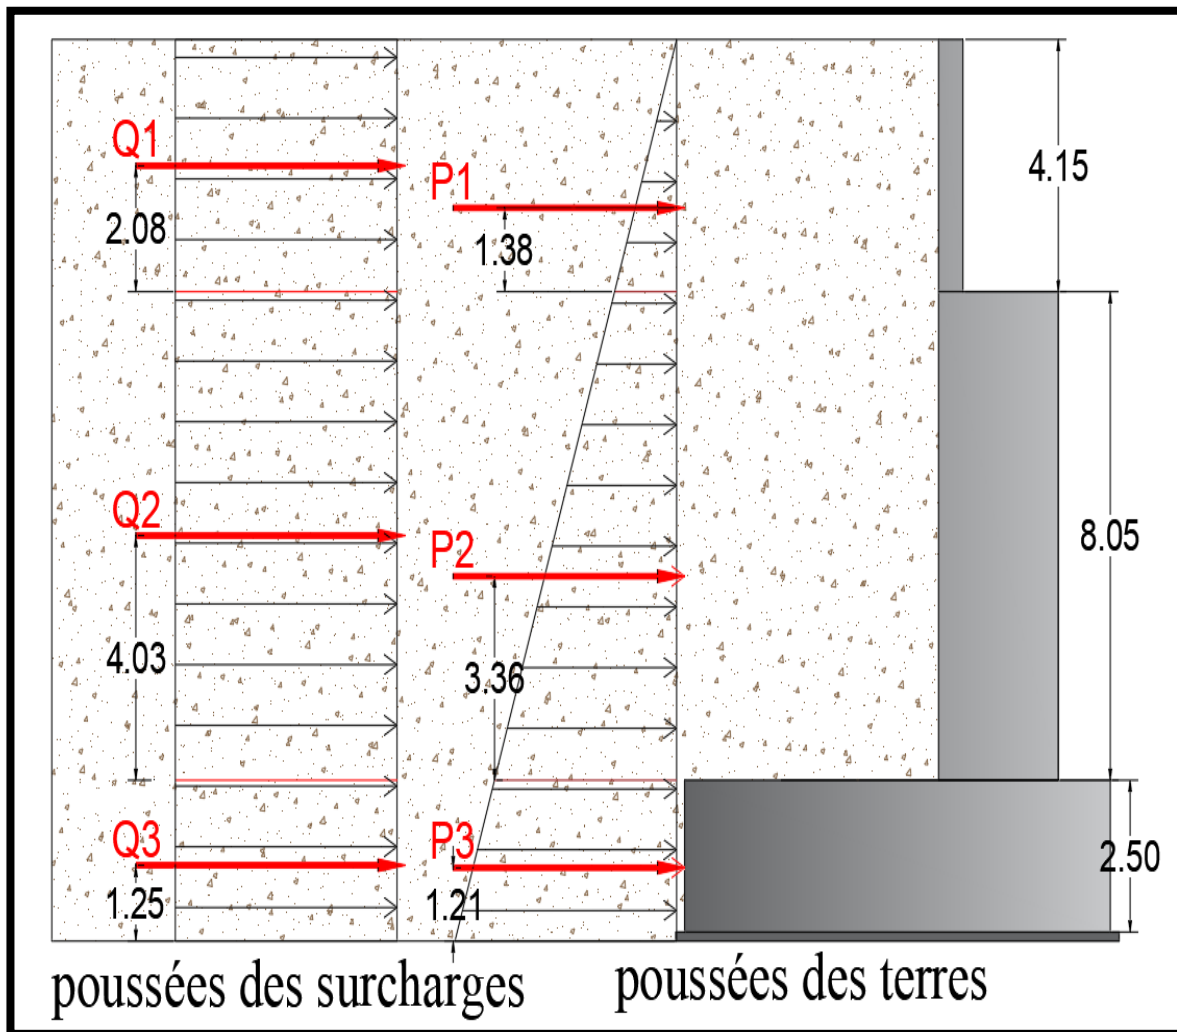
Poussées des terres du au mur garde-grève, mur frontal et la semelle
